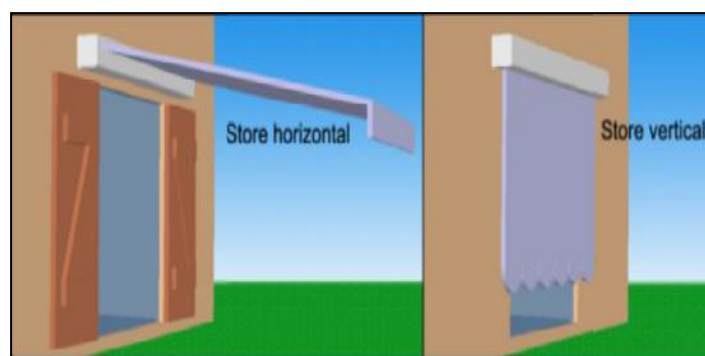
la protection solaire par les stores horizontaux et verticaux
